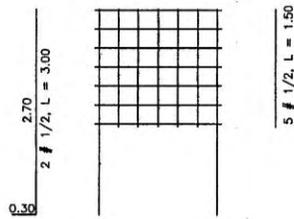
Estructuras de Drenaje Alcantarillas de Tubo 2
